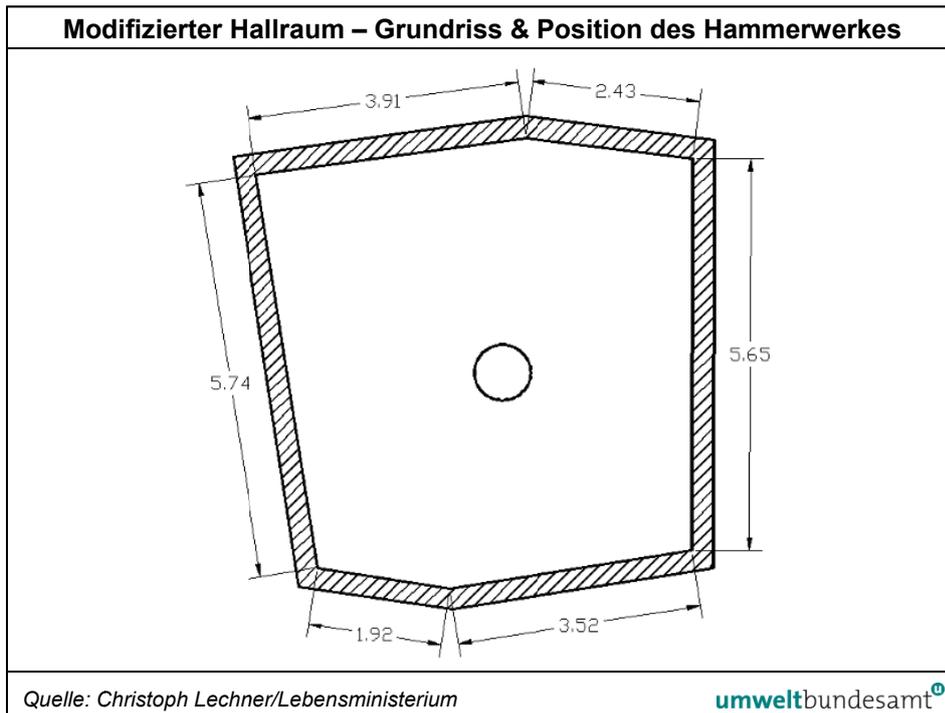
Grundriss des modifizierten Hallraumes mit Situierung des Hammerwerkes.
